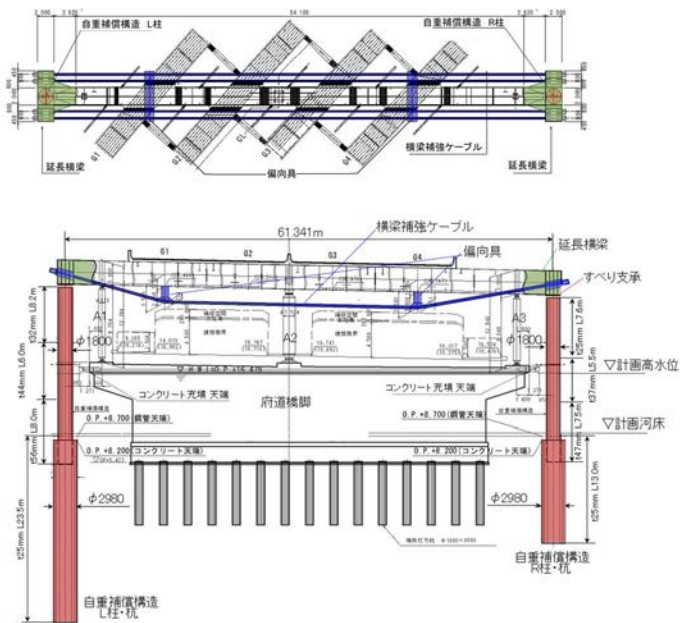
自重補償構造一般図（上段：平面図 下段：正面図）
